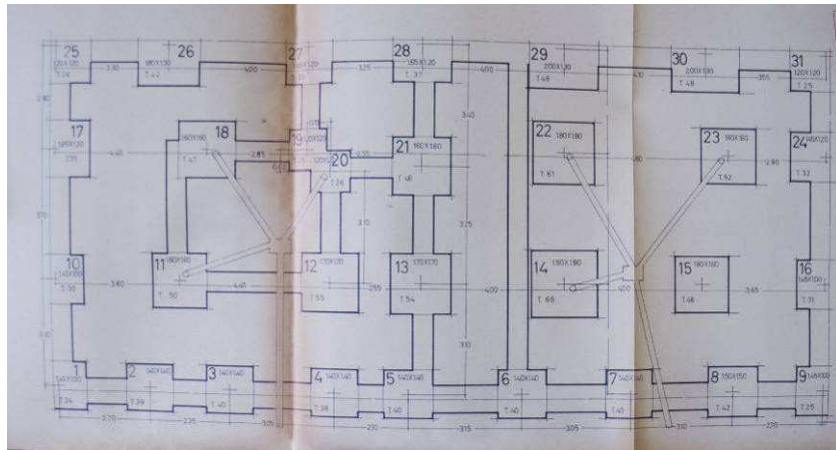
Planta de cimentación. Edificio ficha 167C.011, 1966.
